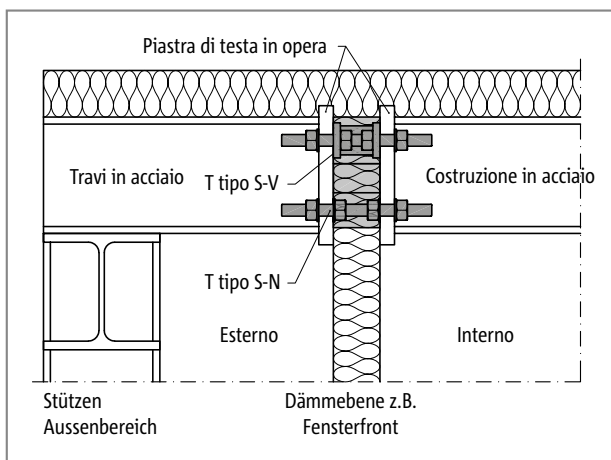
Schöck Isokorb® tipo T tipo S-N e T tipo S-V: isolamento termico all'interno di un'area
